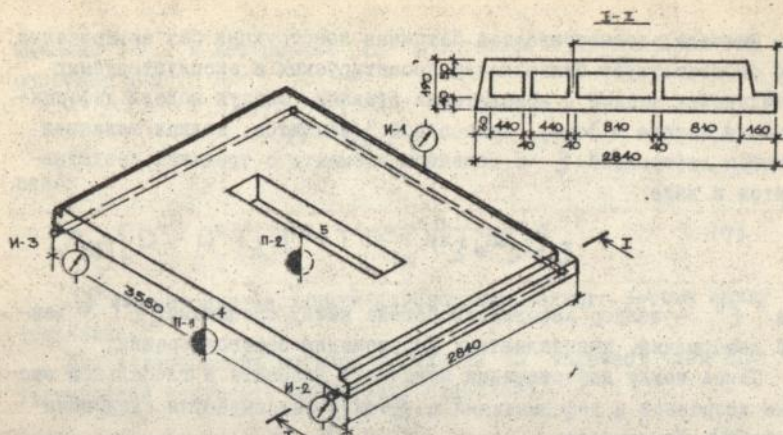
Схема расположения приборов при испытаниях панели перекрытия
